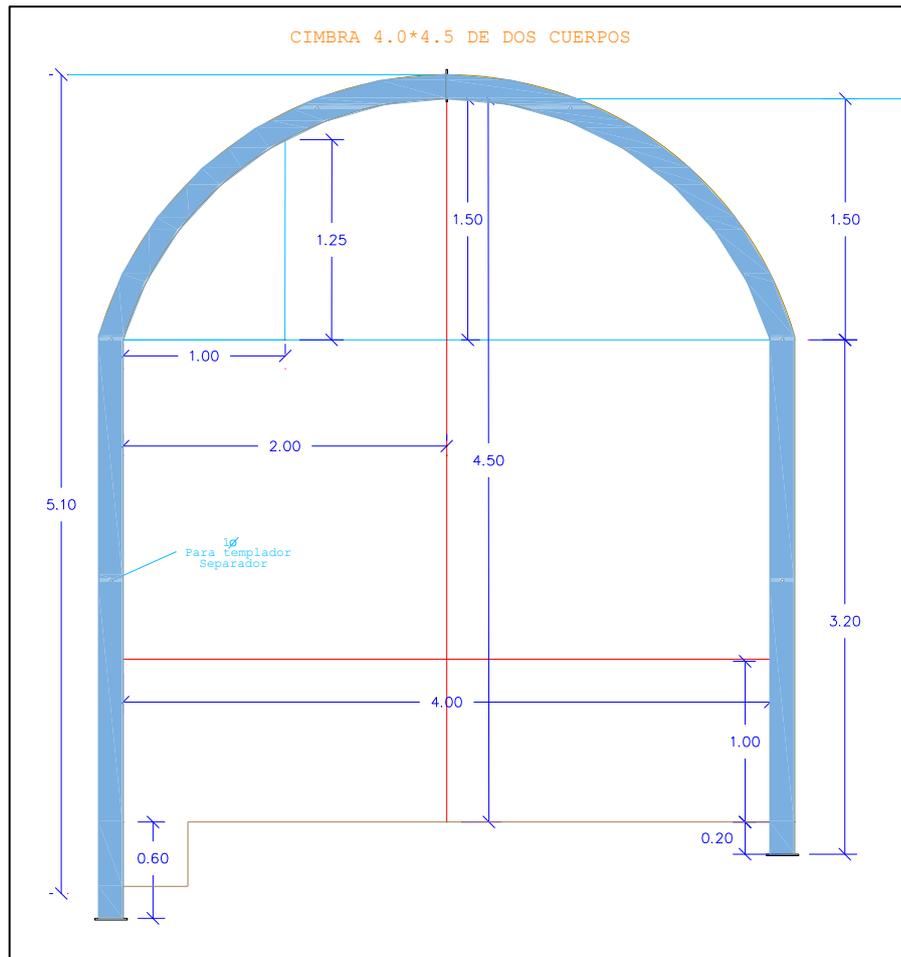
instalación de Cimbra 2 cuerpos en viga H de 6", 4.0 x 4.5 m
